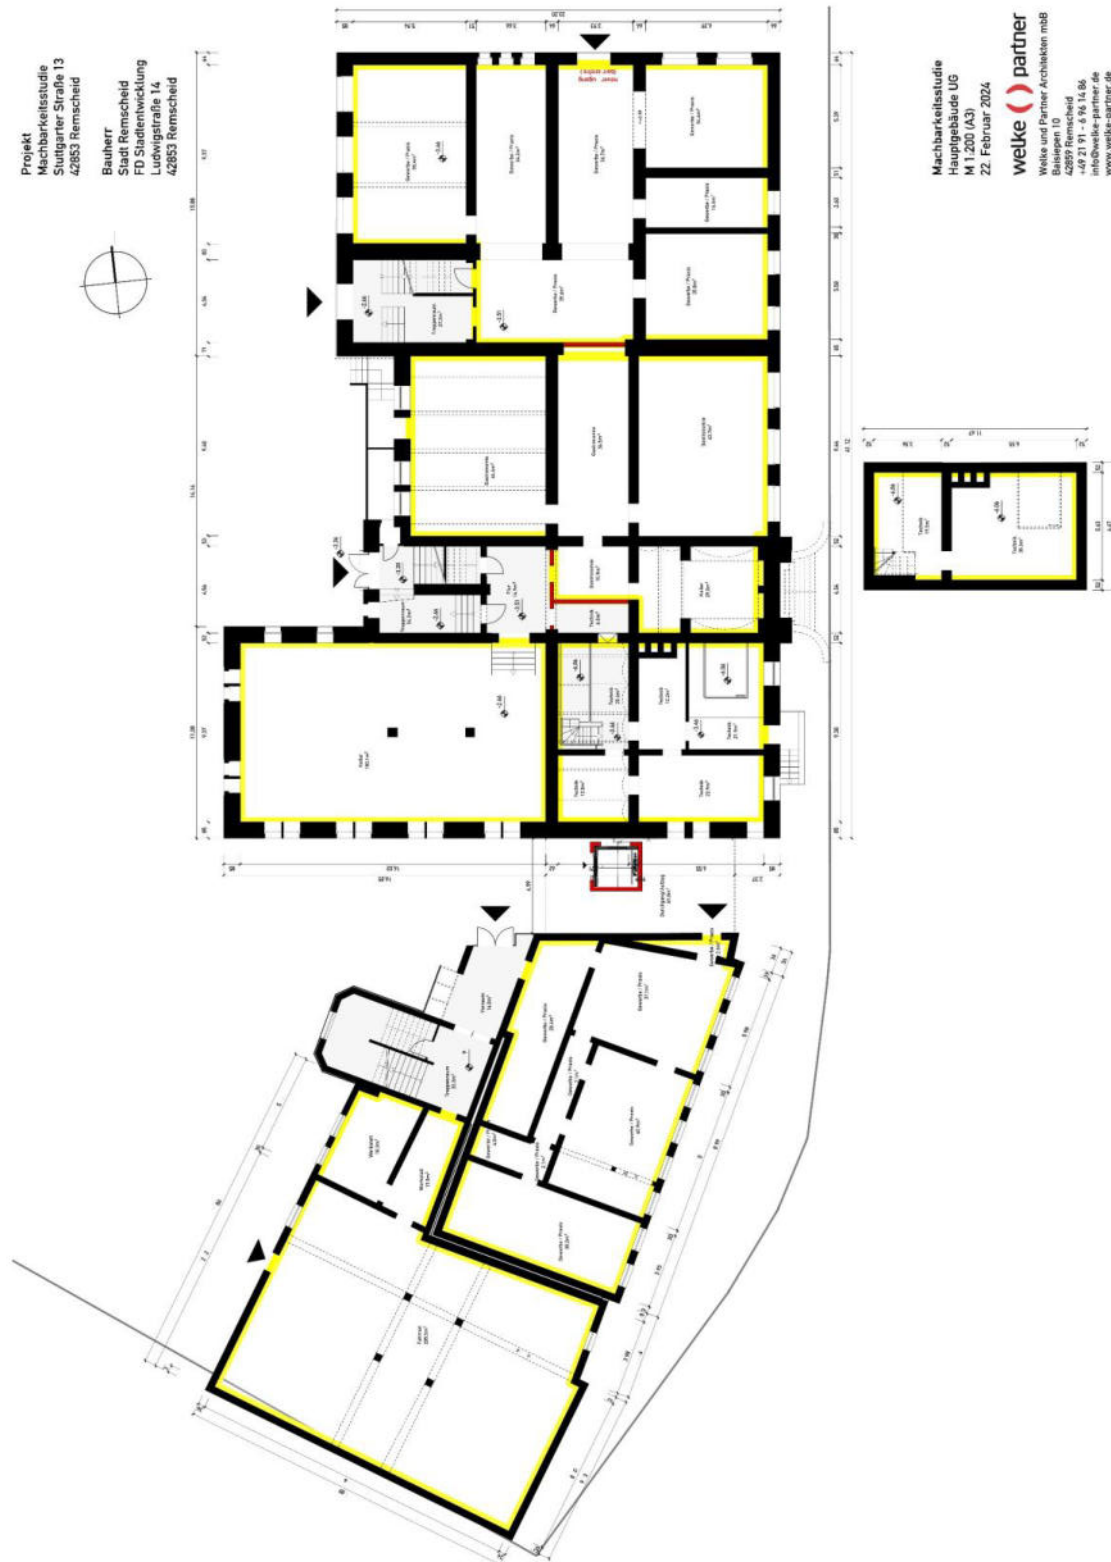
Grundriss Kellergeschoss, o.M.
